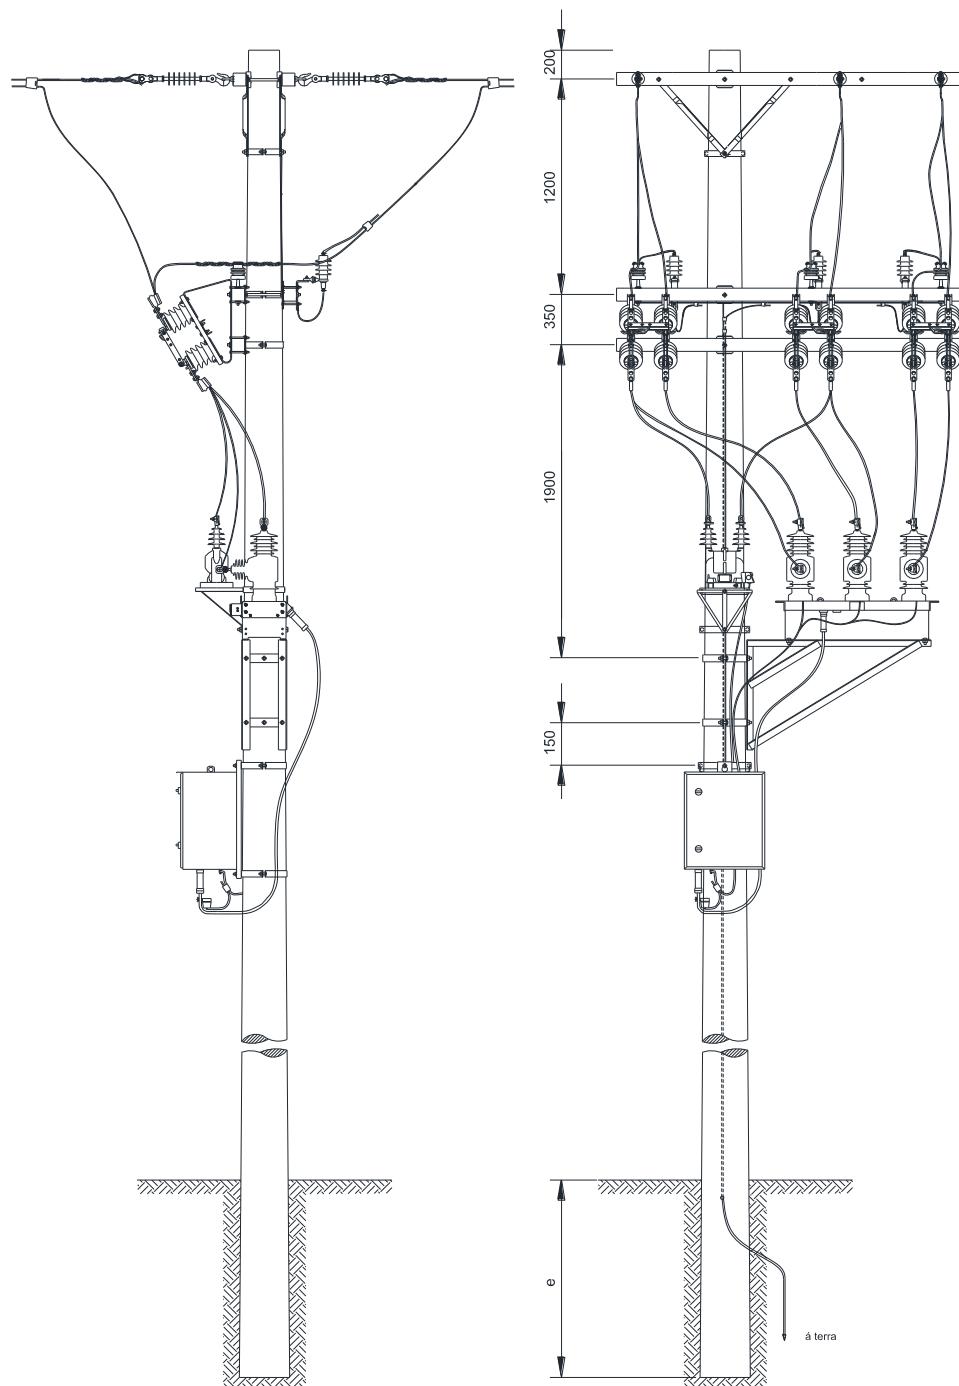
Instalação de equipamento – Religador – Seccionamento tipo faca “bay-pass” – Para-raios no 2º nível
